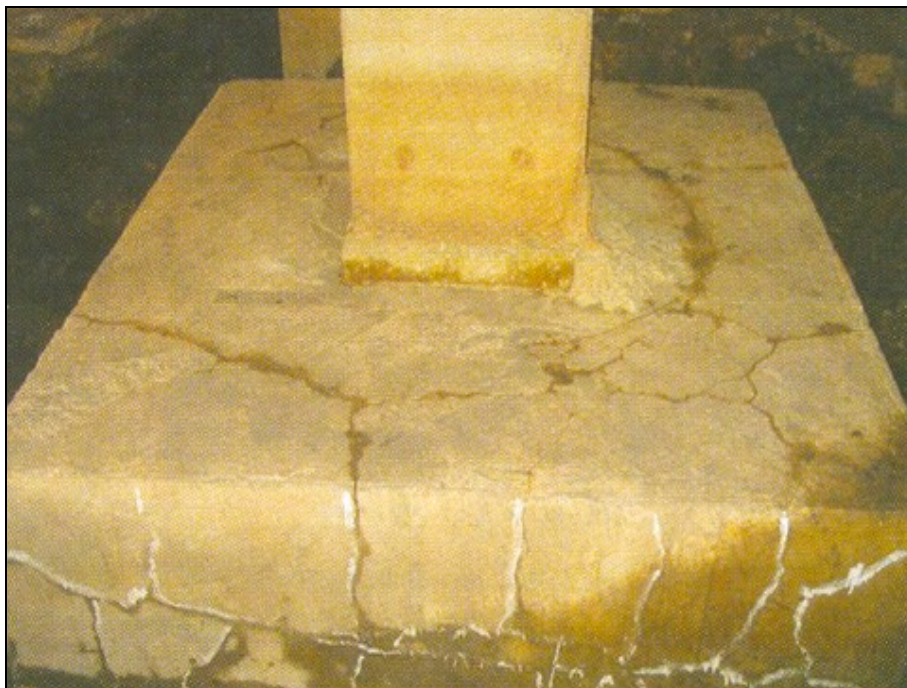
Mapeamento de fissuras em blocos de fundação devido a reação álcali-agregado
